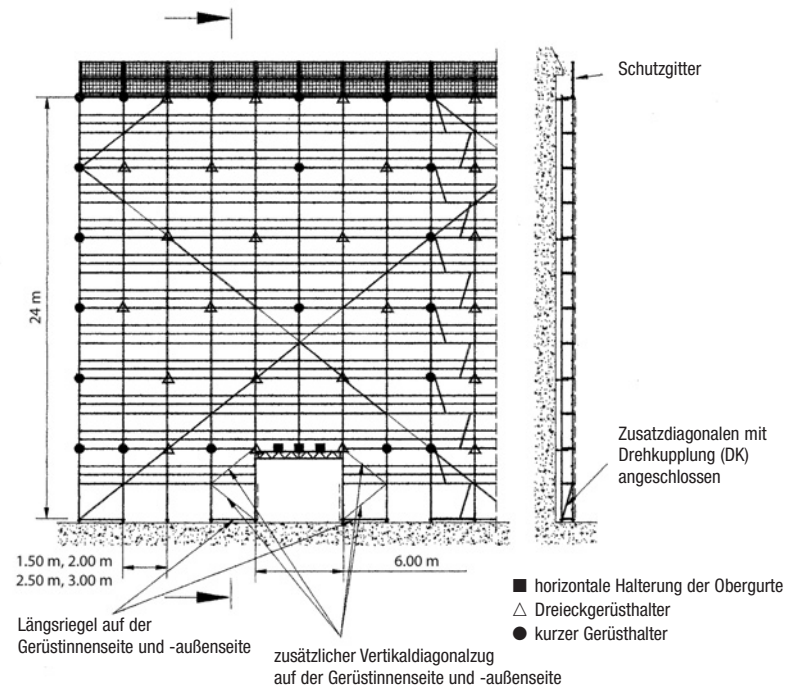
Überbrückungsträger l = 6,00 m eingebaut (ohne Abfangstreben, unbekleidetes Gerüst)
